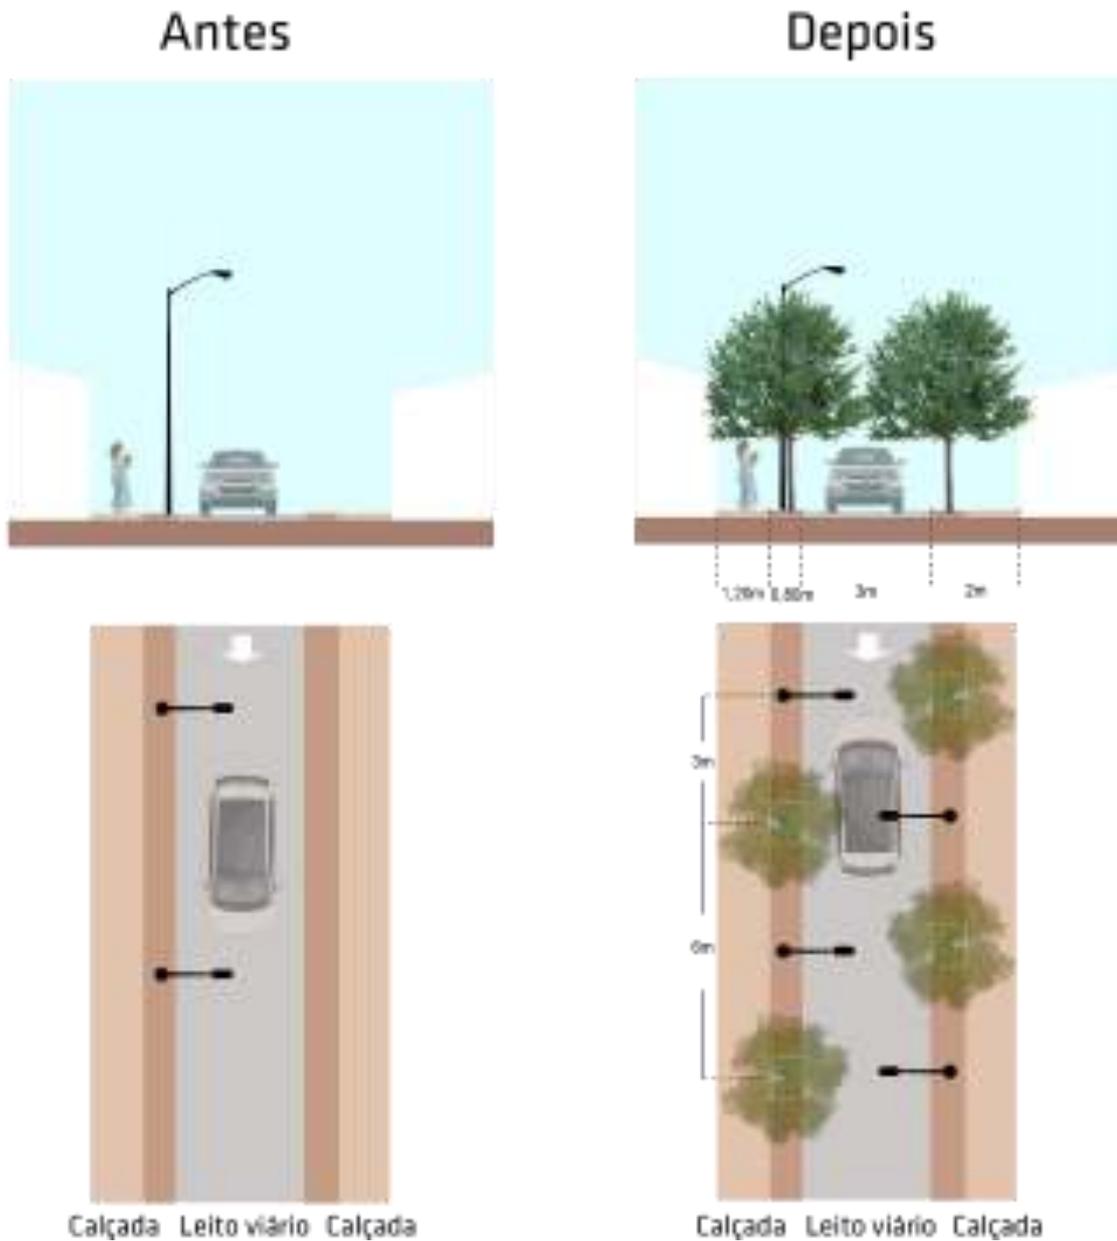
Proposta para a Seção B - Rua Tab. Ildefonso Cavalcante. Fonte: Architectus.
